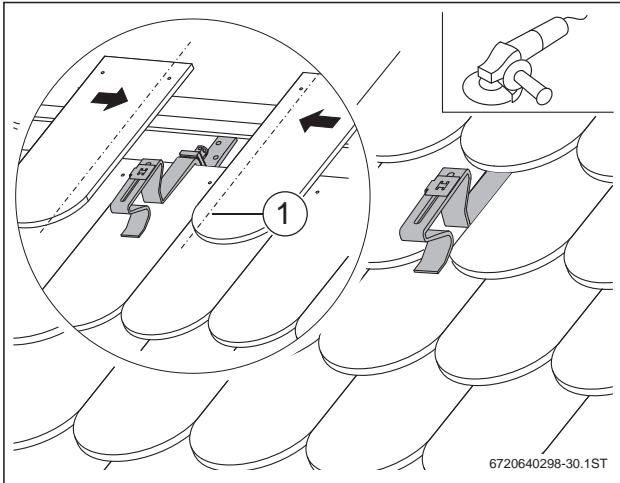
Dachhaken bei Biberschwanz-Eindeckung montiert
